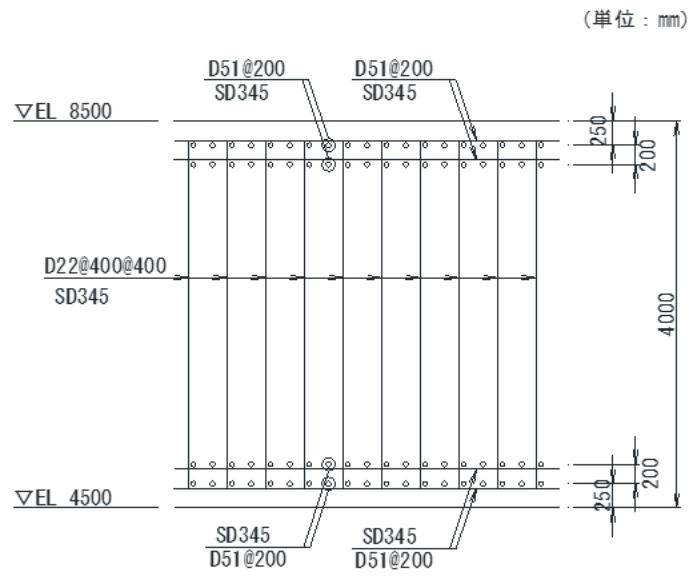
漂流物対策工基礎スラブの概略配筋図 (B-B 断面)
